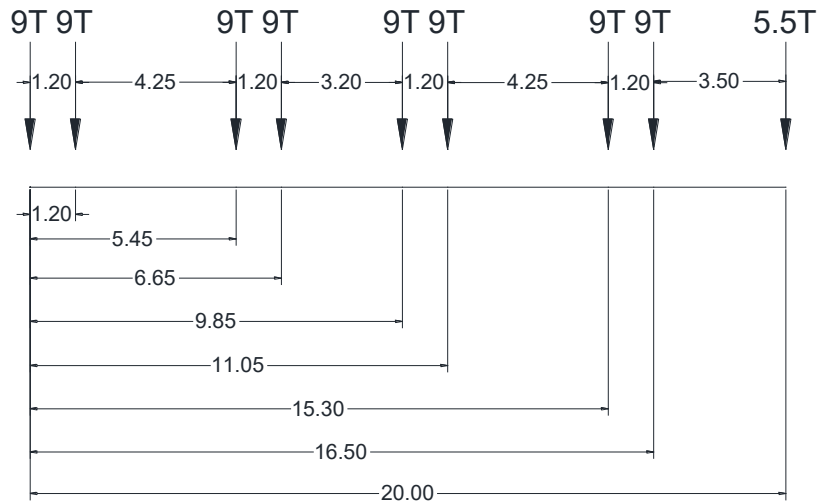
Distribución de las cargas provocadas por los ejes de un camión T3-S2-R4
